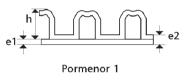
Perfil do tubo corrugado 2DREN de dupla parede – tipo C2
